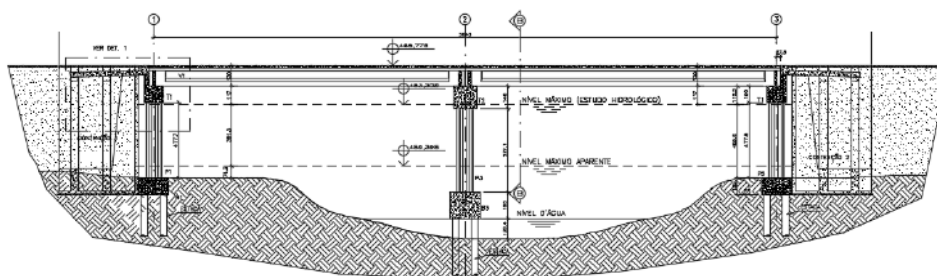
Corte longitudinal da ponte (desenho: EST-02_R04).
